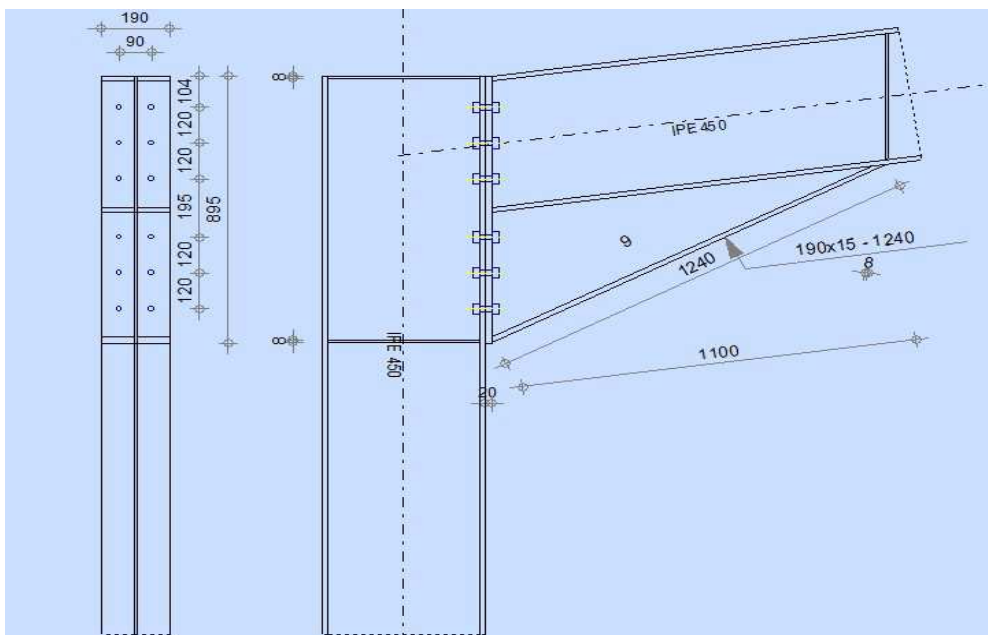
1: vue en plan de l'assemblage poteau-traverse
